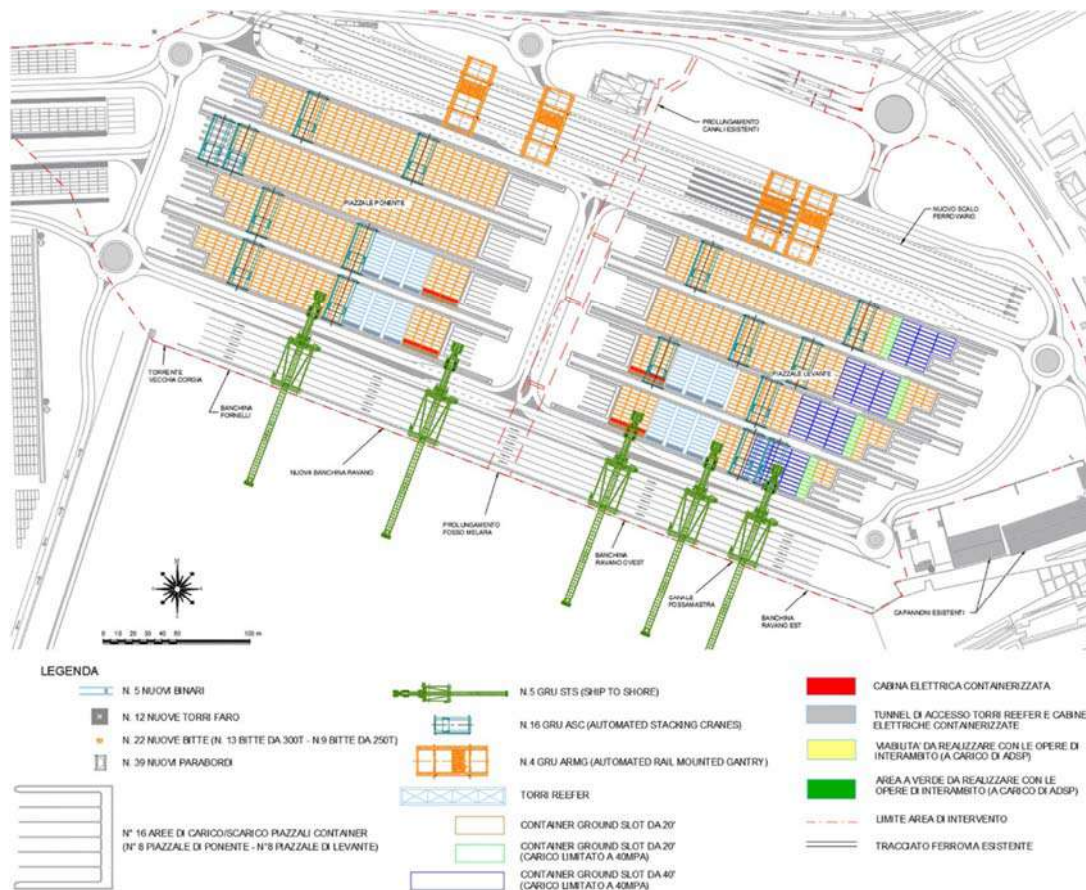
Nuovo terminal Ravano - Planimetria di progetto
